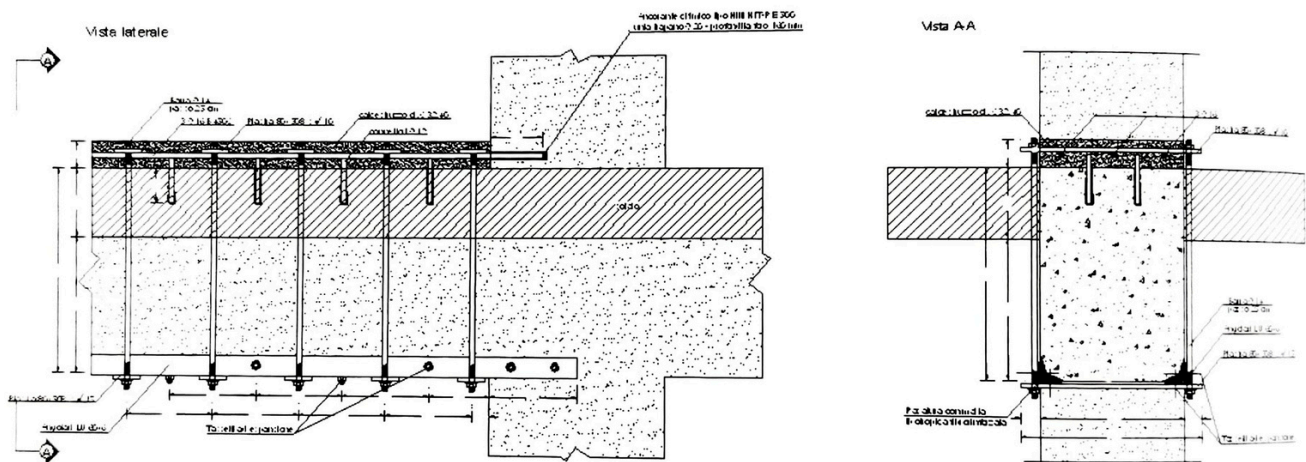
Rinforzo a flessione e taglio delle travi nelle sezioni di estremità.
